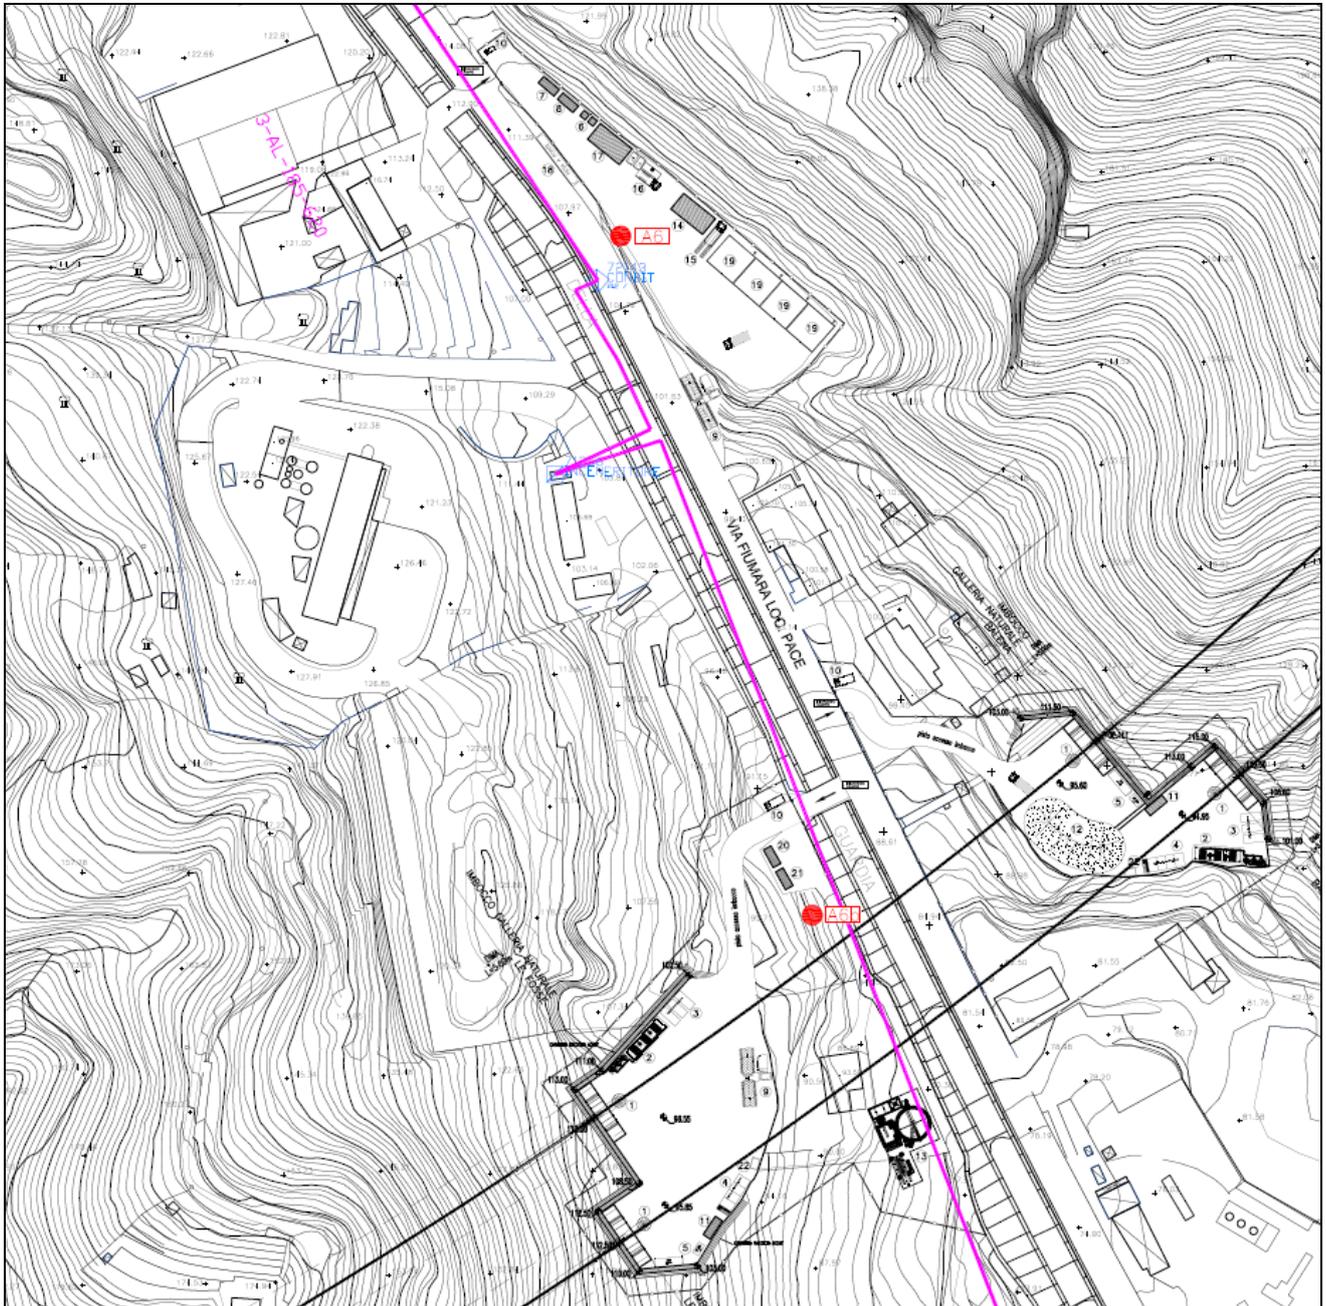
Cantiere SI4 Pace – Localizzazione punti allacciamento
